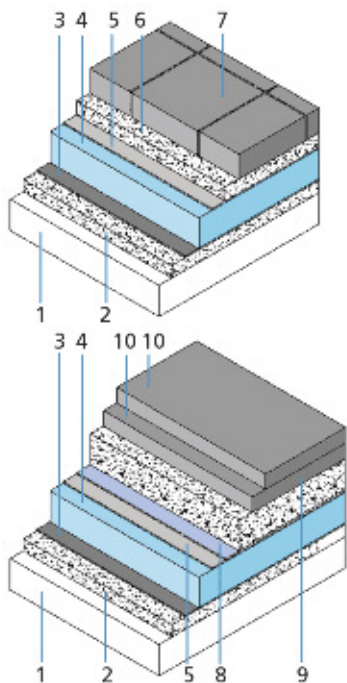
Схема эксплуатируемой крыши (а – с покрытием из тротуарной плитки; б – с покрытием из асфальта): 1 – бетонное основание; 2 – уклонообразующий слой; 3 – гидроизоляционная мембрана; 4 – экструдированный пенополистирол; 5 – геотекстиль; 6 – сухая цементно-песчаная смесь; 7 – тротуарная плитка; 8 – полиэтиленовая пленка; 9 – армированная ж/б плита; 10 – асфальт (1 или 2 слоя)
